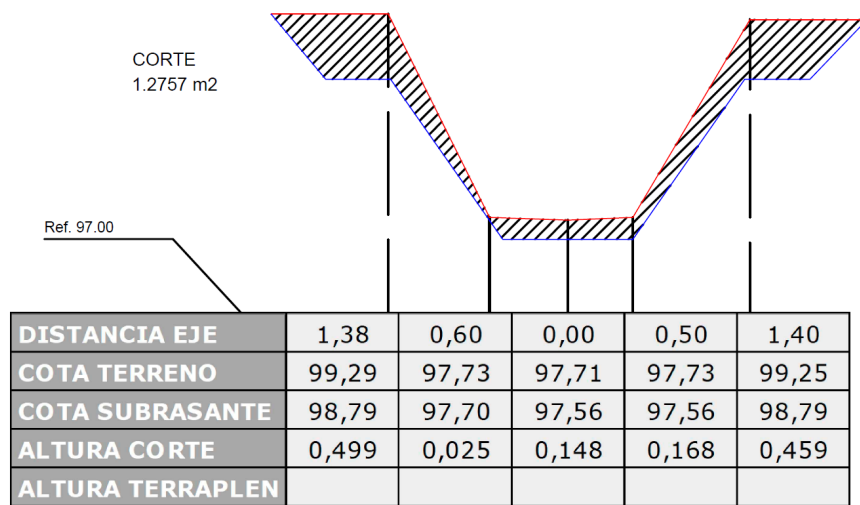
Perfil Transversal N°8 (Fuente Propia)
